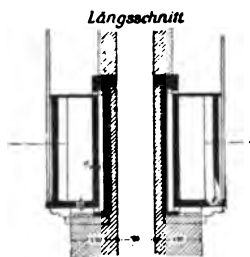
Behälter an einem Fabrik-schornstein Hunebelle.
